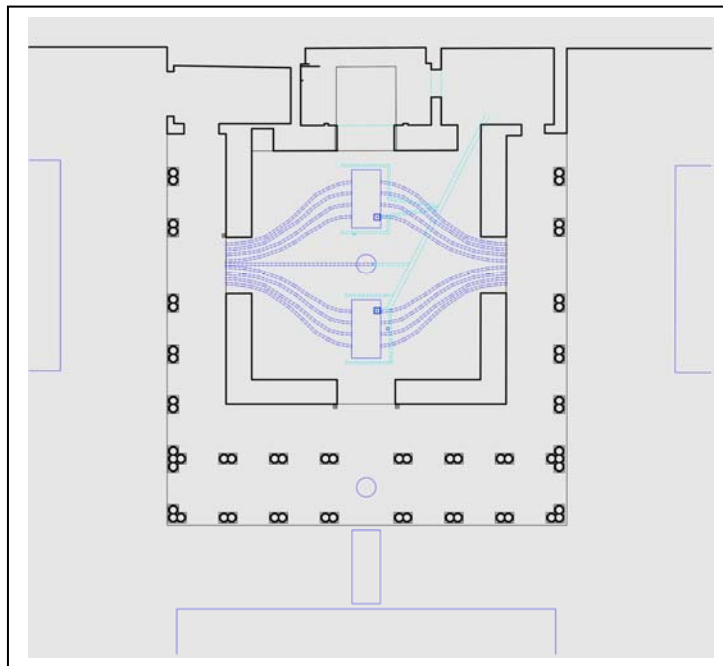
Plan du pavillon ouest du palais de al-Badi' (A. Almagro).
